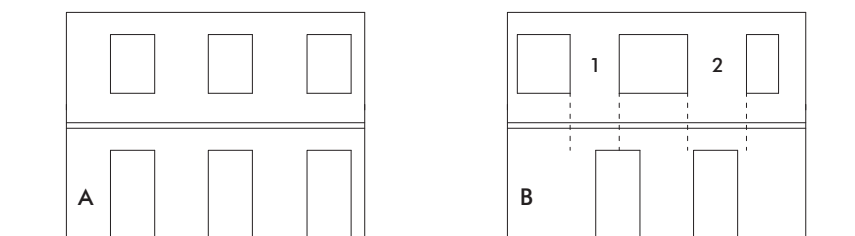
Configurazione in prospettiva. A: Configurazione ottimale, i setti murari sono allineati ai vari piani. B: Il setto 1 non trova valido appoggio alla sua destra. Il setto 2, pur non trovando corrispondenza al piano inferiore, ha validi appoggi da ambedue i lati.
